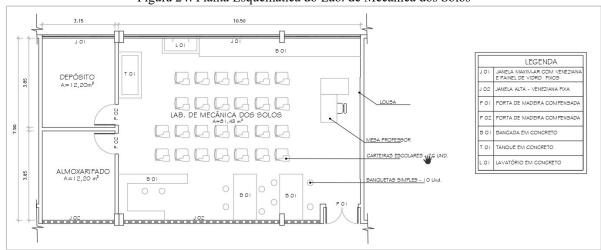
Planta Esquemática do Lab. de Mecânica dos Solos
